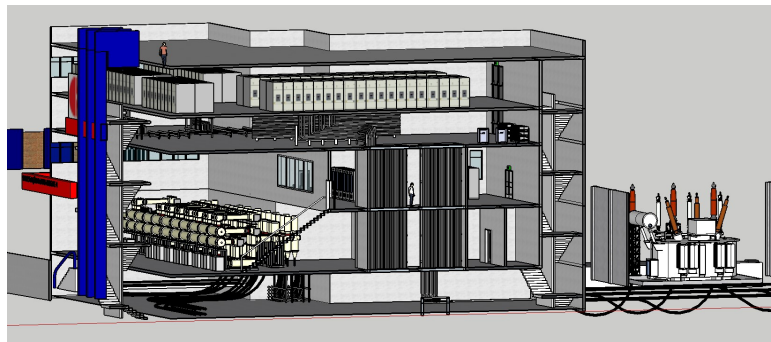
(c) Vista em corte demonstrando o traçado dos equipamentos internamente ao prédio.
